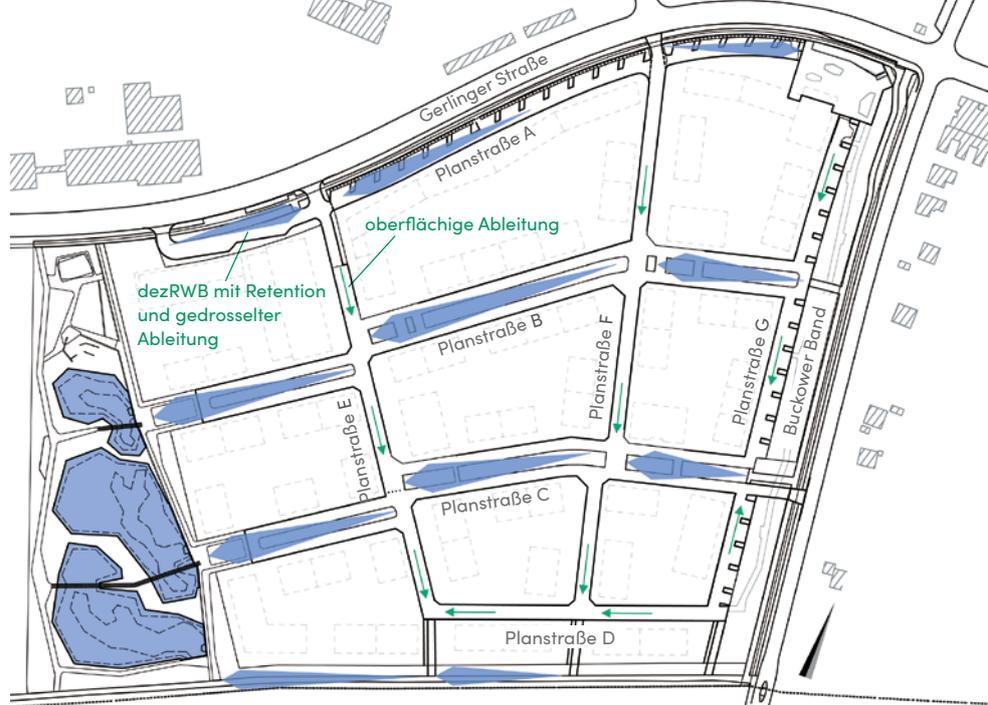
Fließschema der dem Geländegefälle folgenden mehrstufigen Verkehrsflächenentwässerung: oberflächige Ableitung, dezentrale Retention, Verdunstung und Versickerung sowie gedrosselte Ableitung in drei Retentionsmulden wirken hier zusammen
